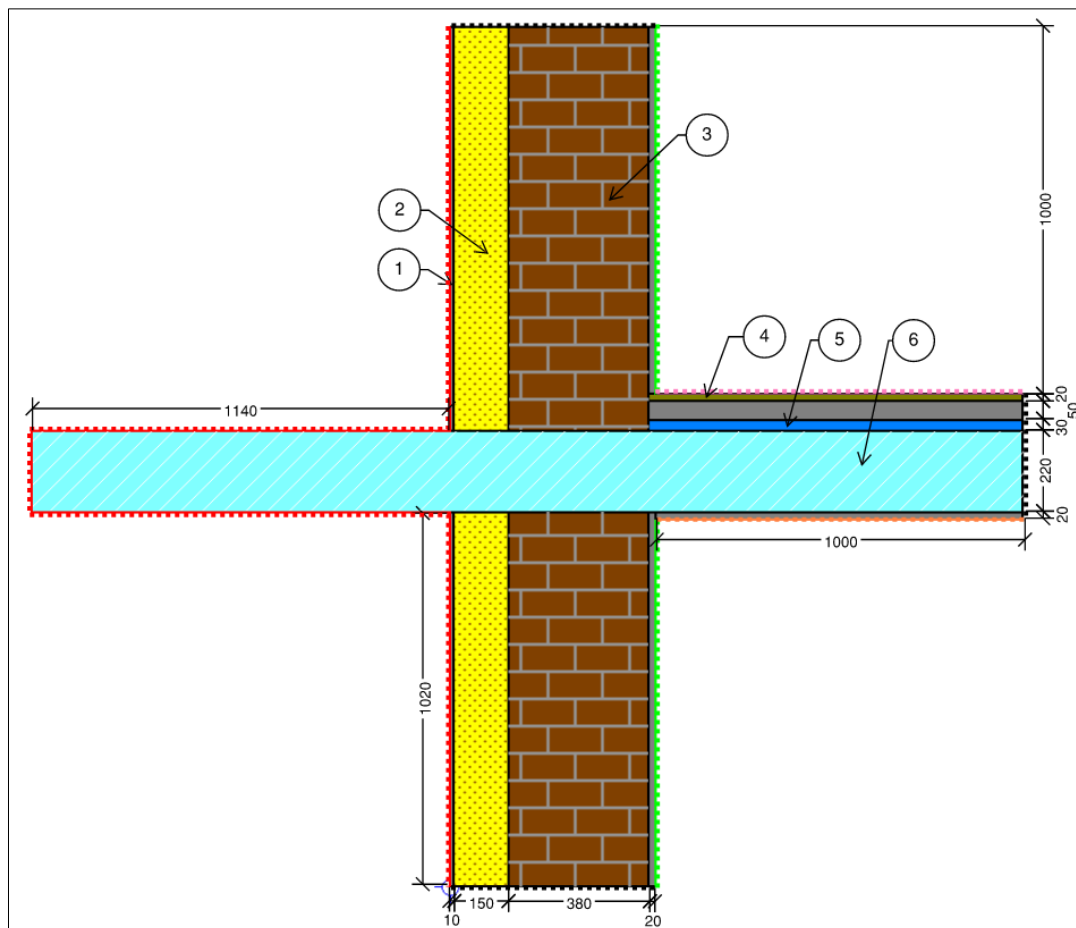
Схема базового вузла примикання зовнішніх стін до балконного перекриття
